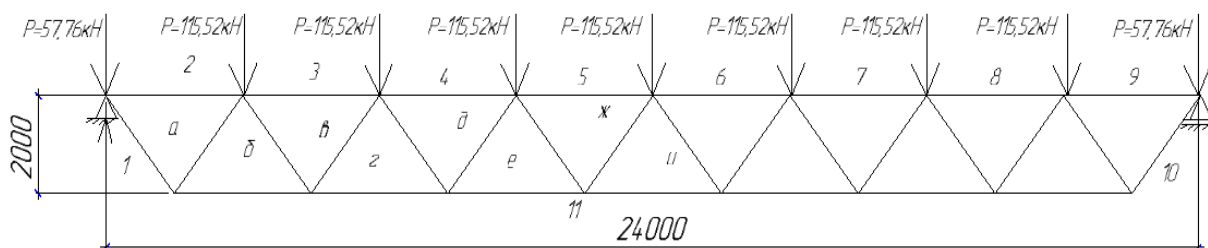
Схема загрузки стальной стропильной фермы
